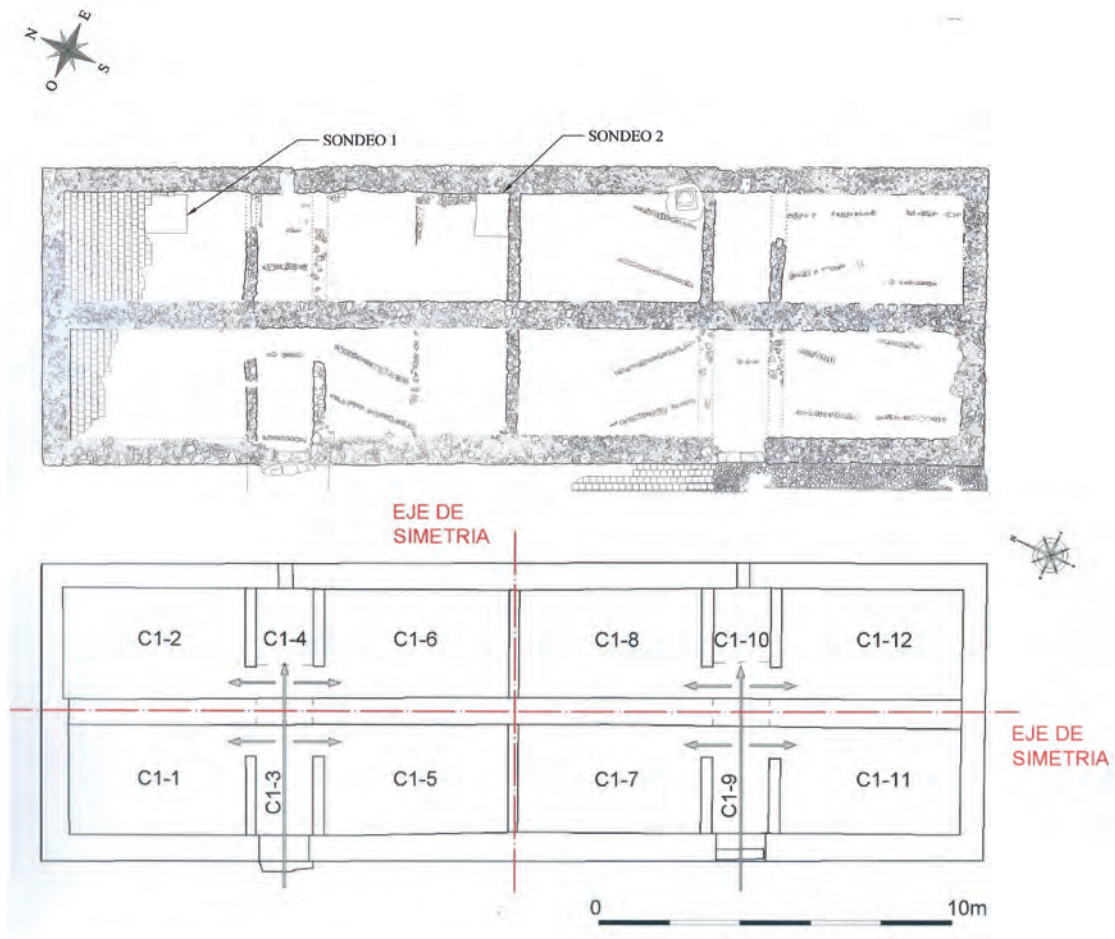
Esquema con indicación de las estancias y representación de los ejes de simetría del cuartel. Planta excavación.
